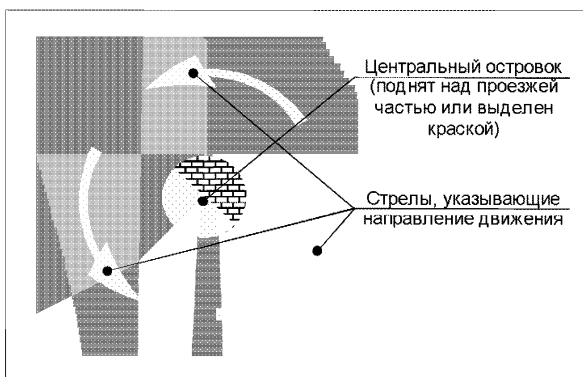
Разметка, указывающая направление движения на проезжей части мини-кольцевого пересечения
